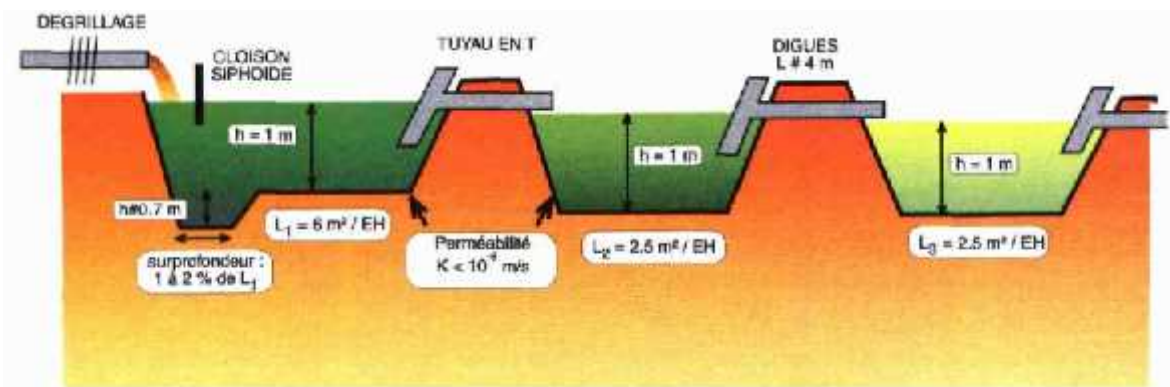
Schéma d'une filière de lagunage type (AERM, 2007)
